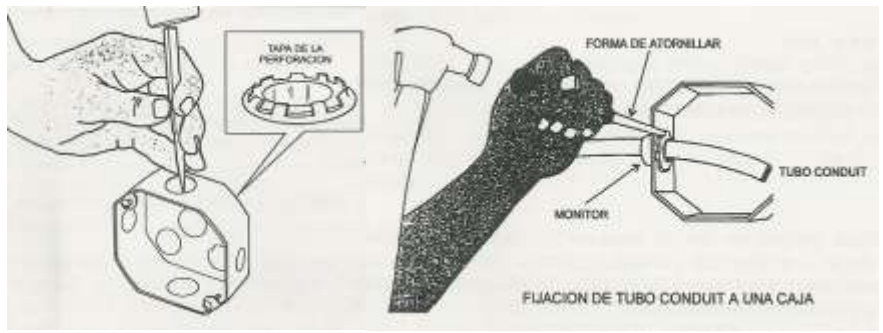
Perforación de una caja metálica y fijación de un tubo conduit a la caja metálica.
